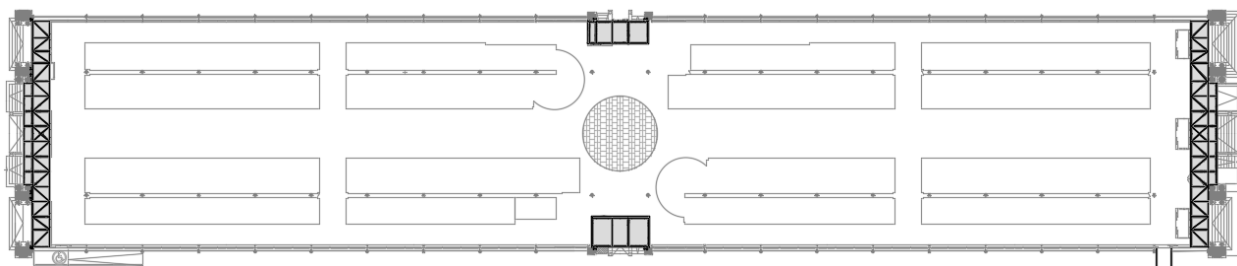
Planta de celosías horizontales para soporte de vidrio
